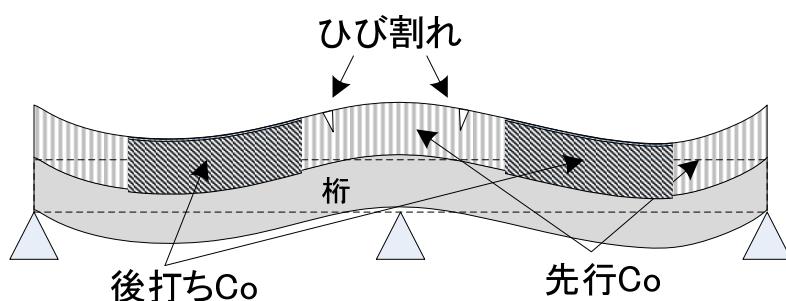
誤った床版コンクリートの打設順序によるひび割れイメージ
